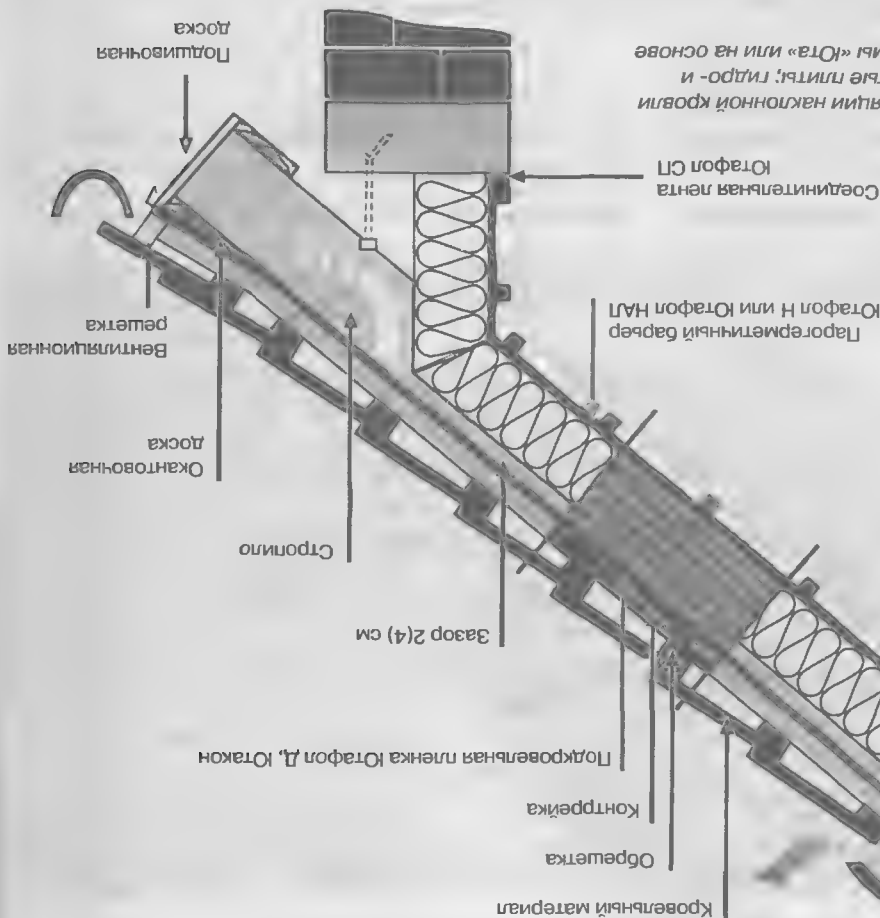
Устройство утепления и изоляции наклонной кровли (теплоизоляция – базальтоволокнистые плиты; гидро- и пароизоляция – из материалов фирмы «Юта» или на основе систем «Изопан») (рис. 3а)
